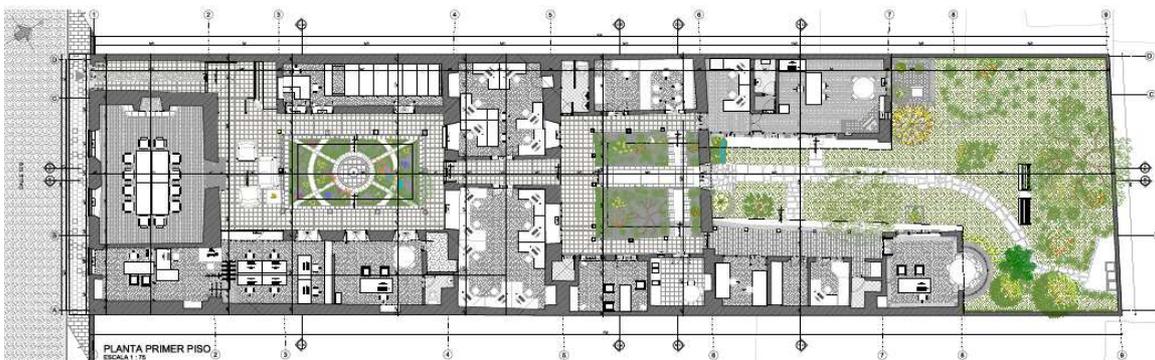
Levantamiento planimétrico de la sede Principal. Planta primer piso
